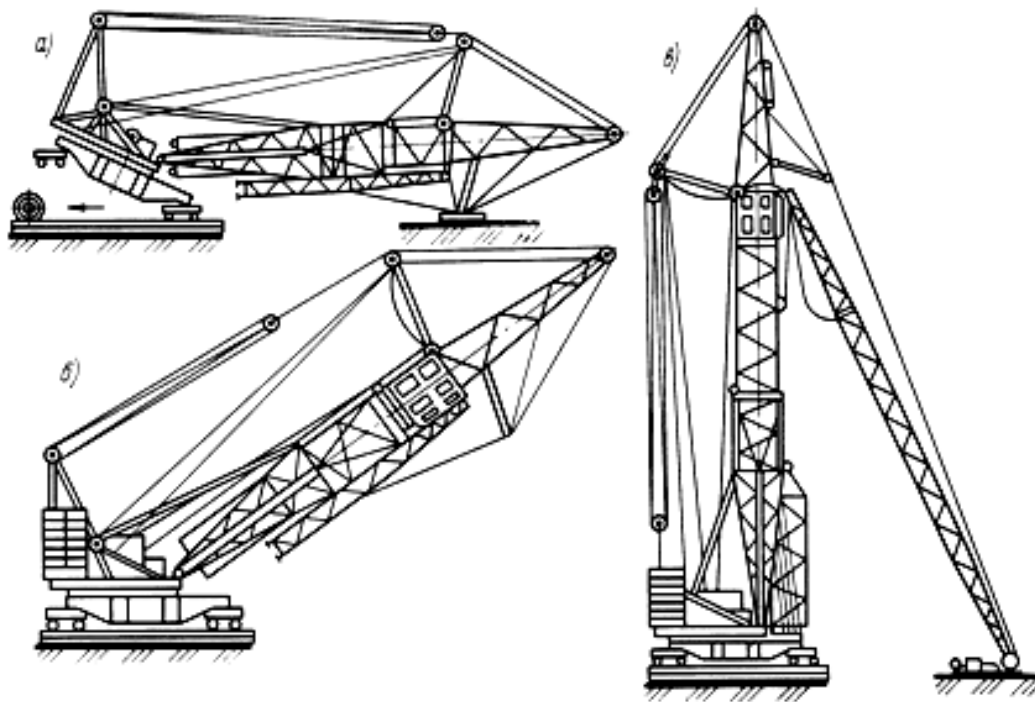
Схема монтажа башенных кранов с поворотной платформой серии КБ: а – начало монтажа; б – подъем башни со стрелой; в – подращивание башни
